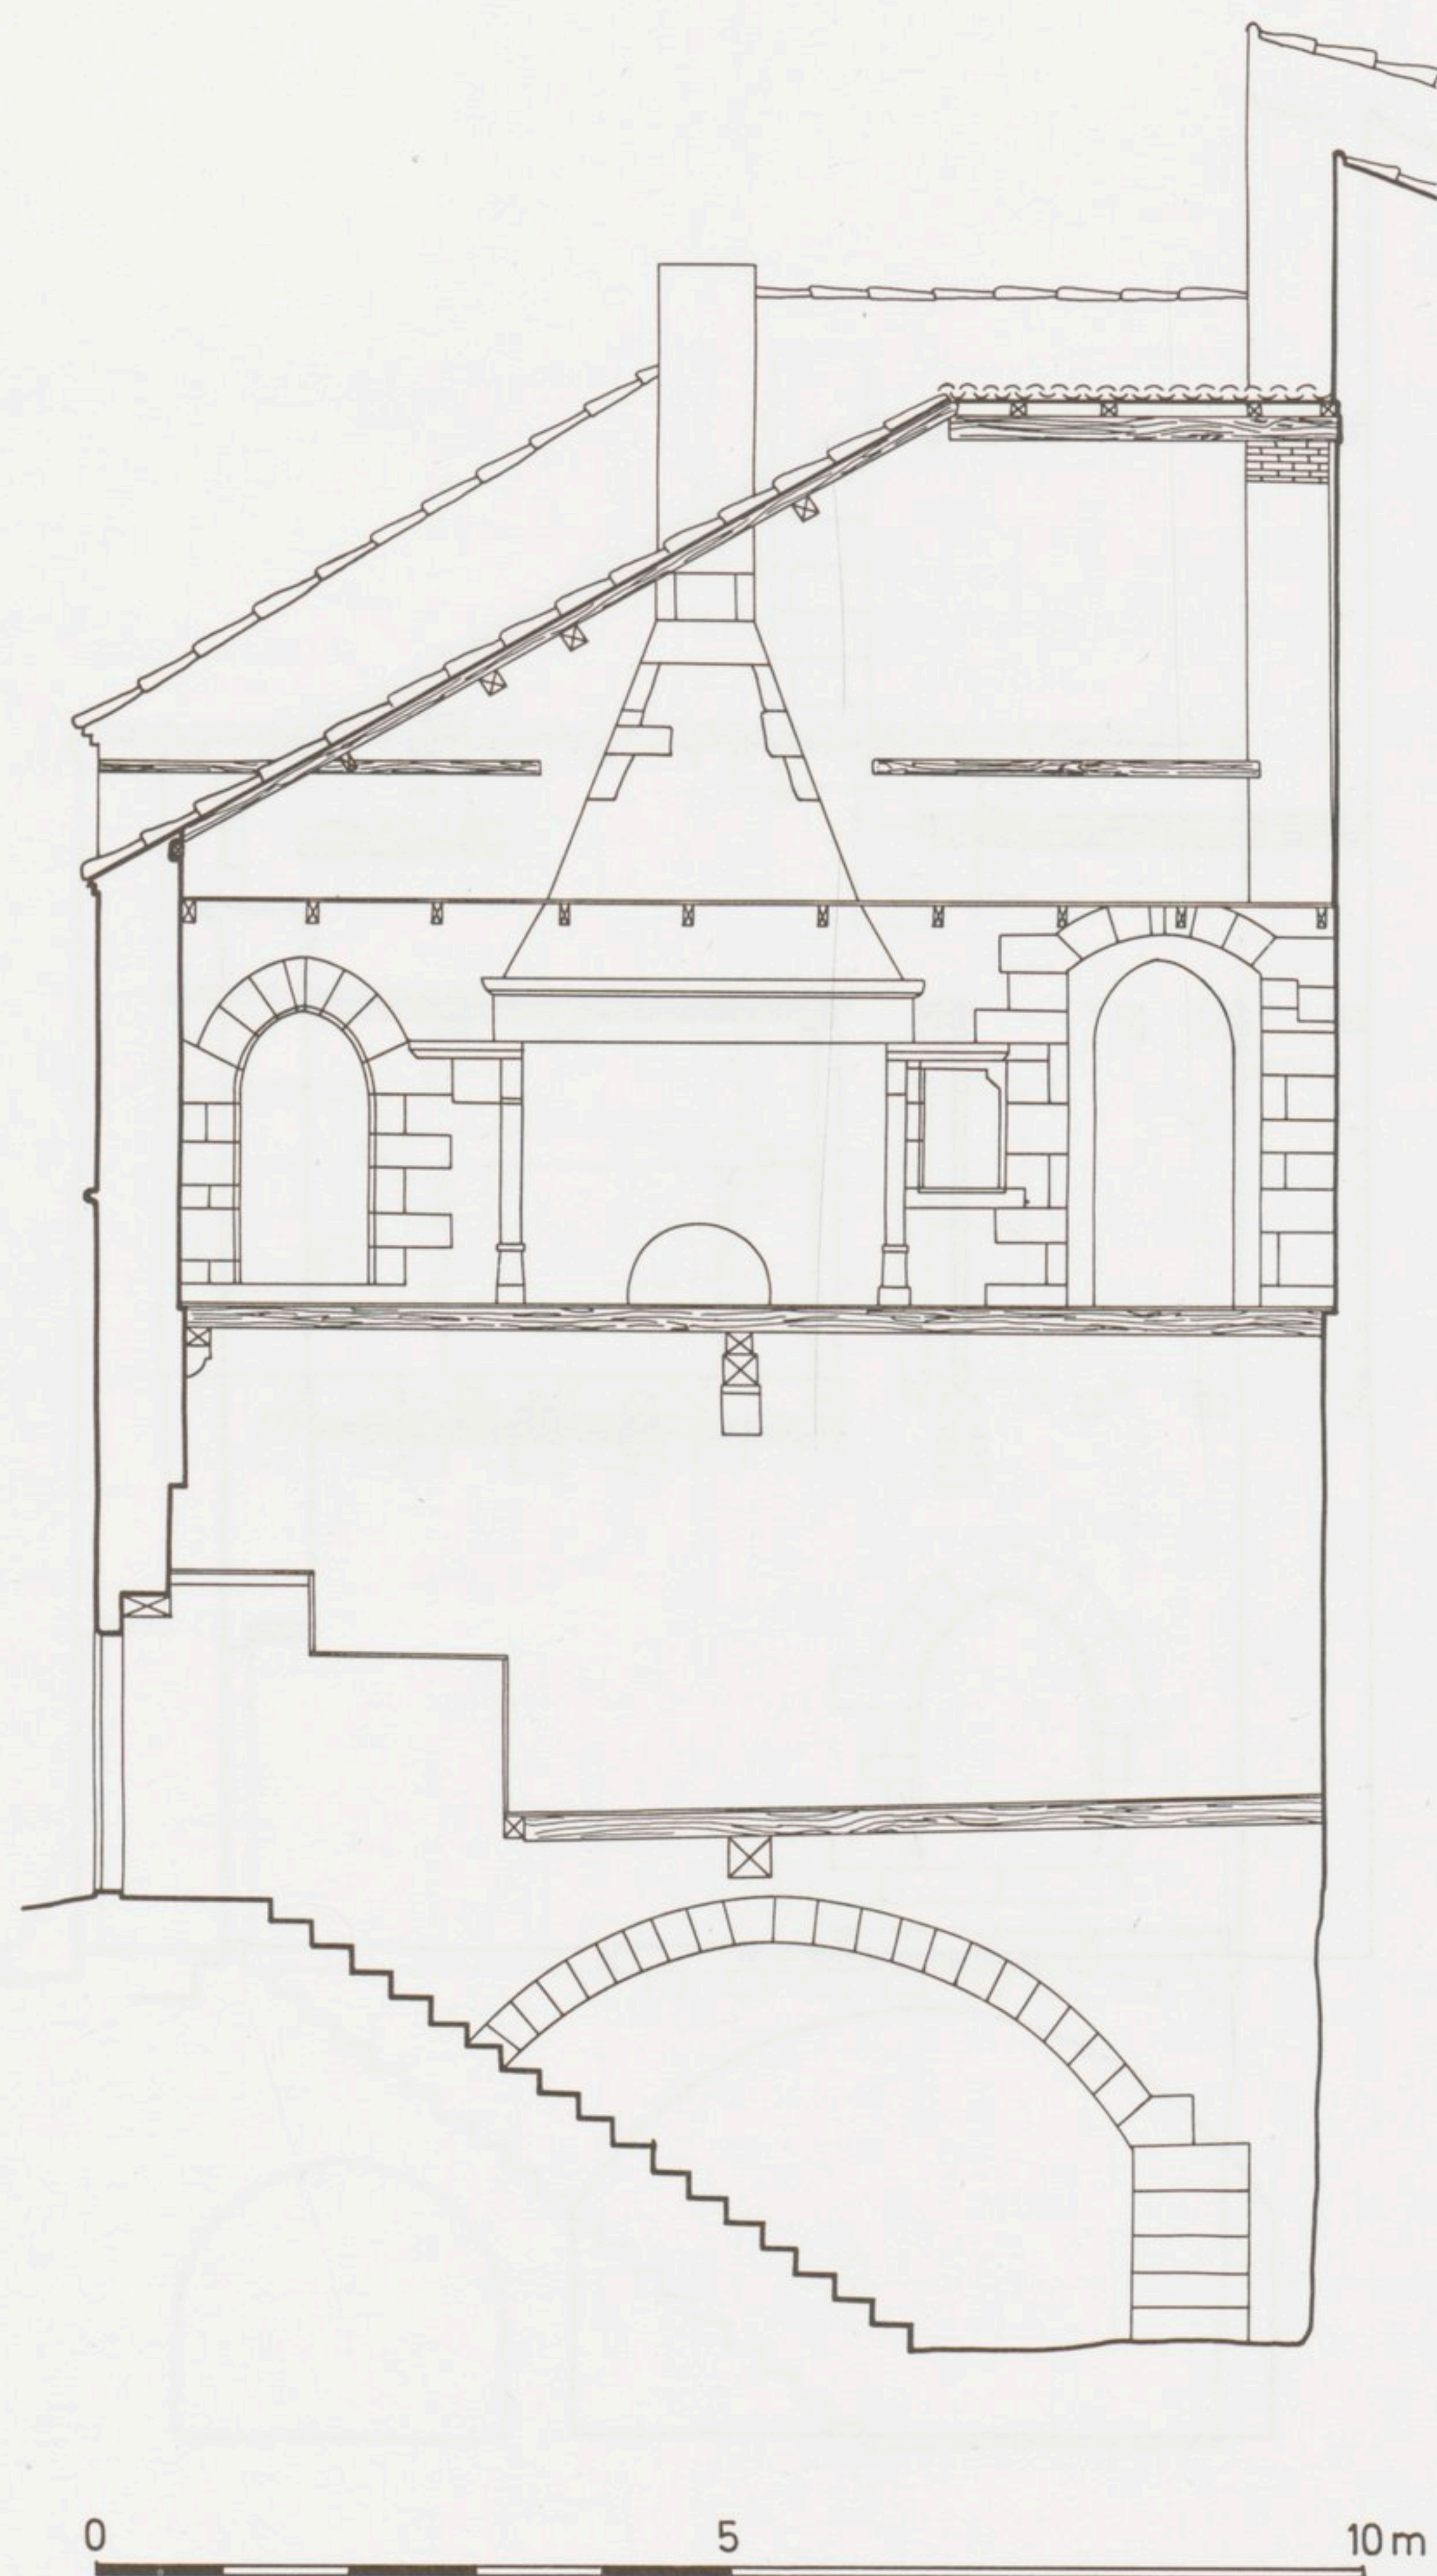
RUE BASSE, COUPE EST-OUEST ET ELEVATION NORD DU MUR DE REFEND, état actuel (Relevé P. Roques).
